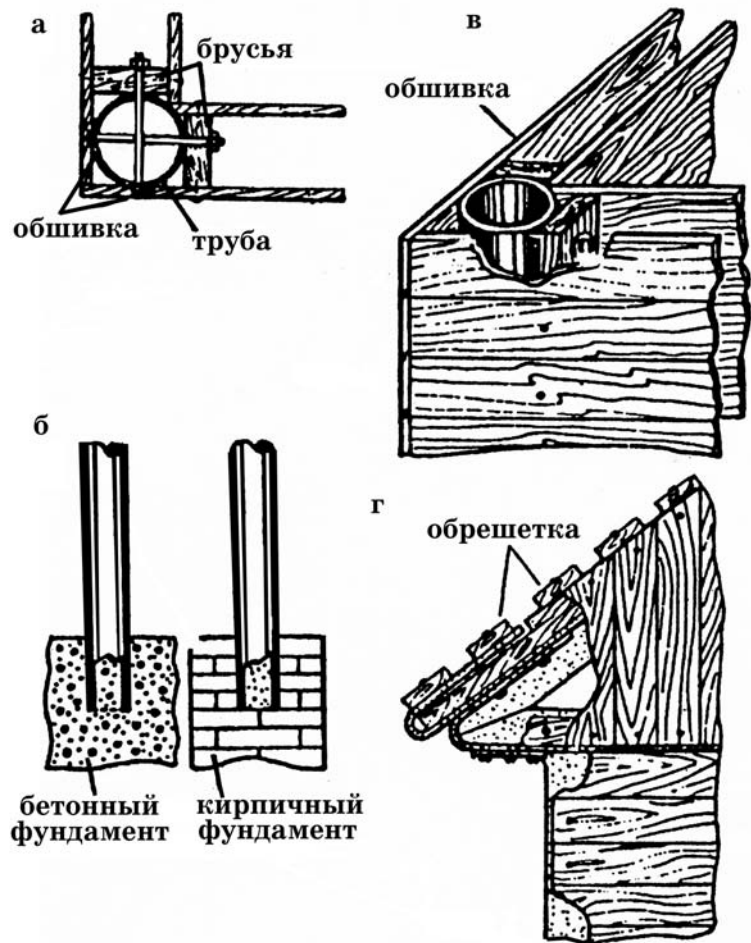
а — взаимное соединение досок обшивки стен, брусьев и трубы. Брусья к трубе крепятся болтами с гайками, если нет возможности установить гайку, в стенке трубы нарезается резьба; б — закрепление металлических опор в фундаменте; в — для наружной и внутренней обшивки, выполненной из досок, к уголкам на болтах или шурупах прикрепляются легкие брусья; г — пример обшивки стен и фронтона.
